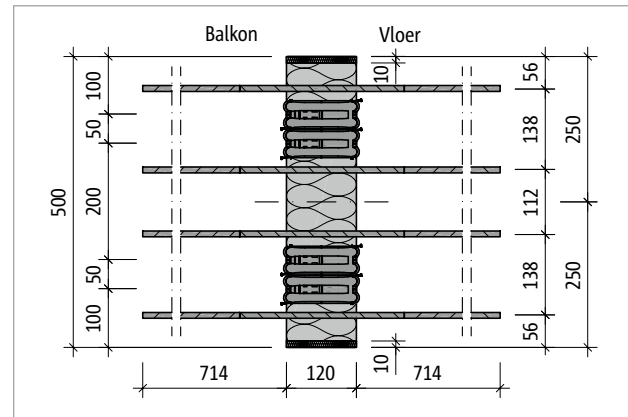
Schöck Isokorf® XT type Q-E-V4: Bovenaanzicht
